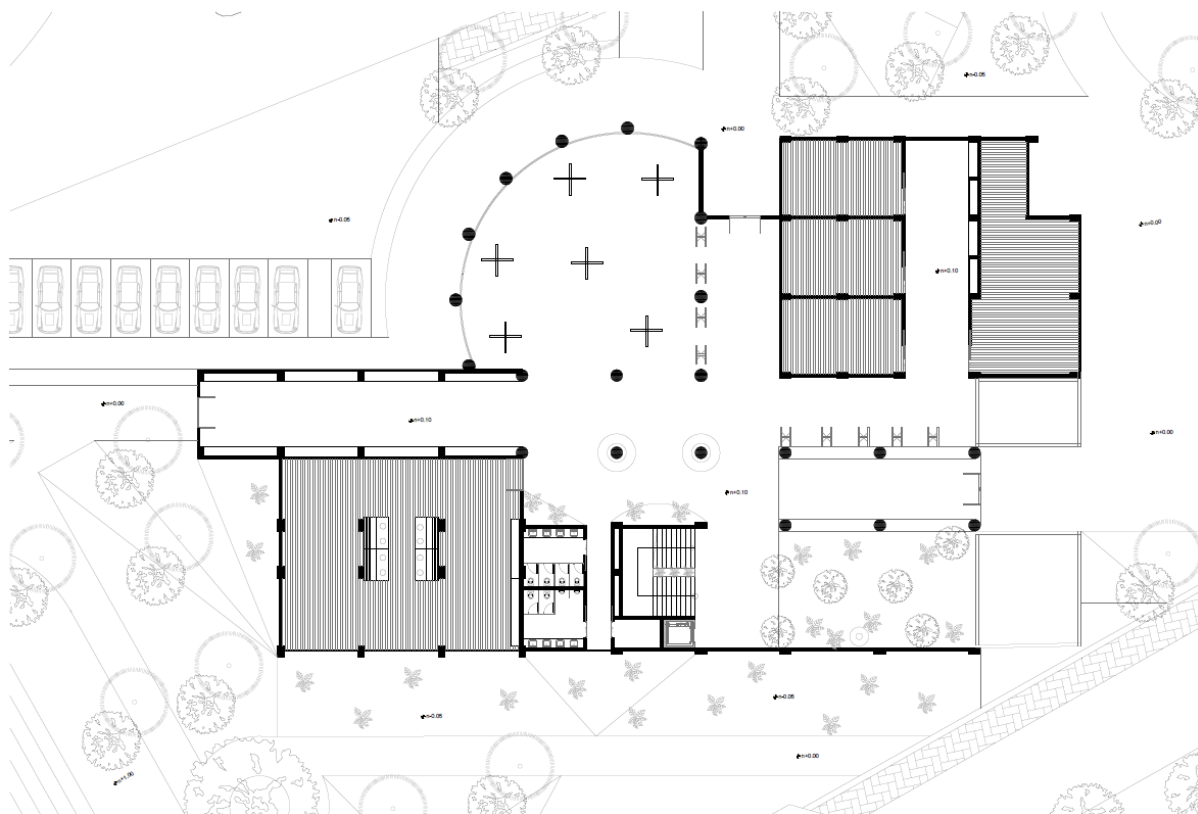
Planta baja de la Facultad de Diseño Artesanal e Industrial.
